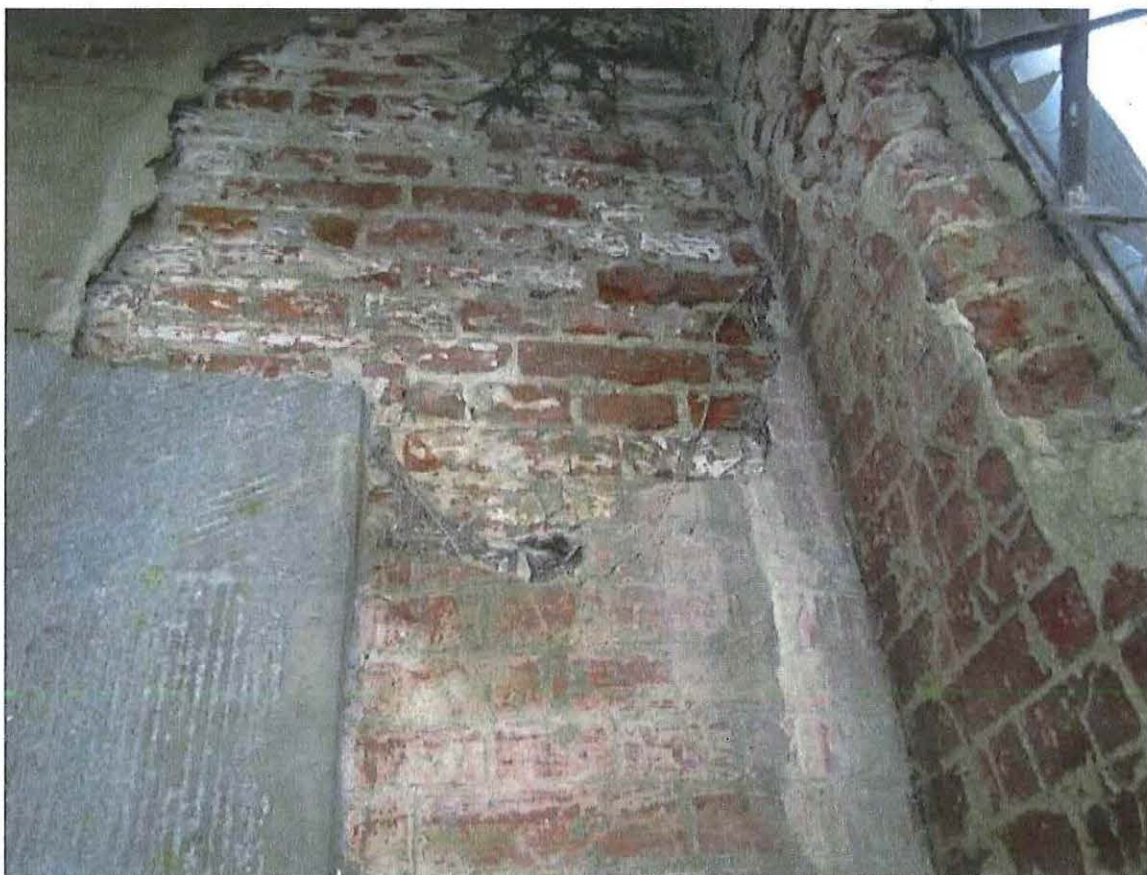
Detail buitenmuren met pleisterwerk met afwerking in baksteenimitatie van de kapelportiek van de bovenbouw (© Triconsult 07/02/2017).
